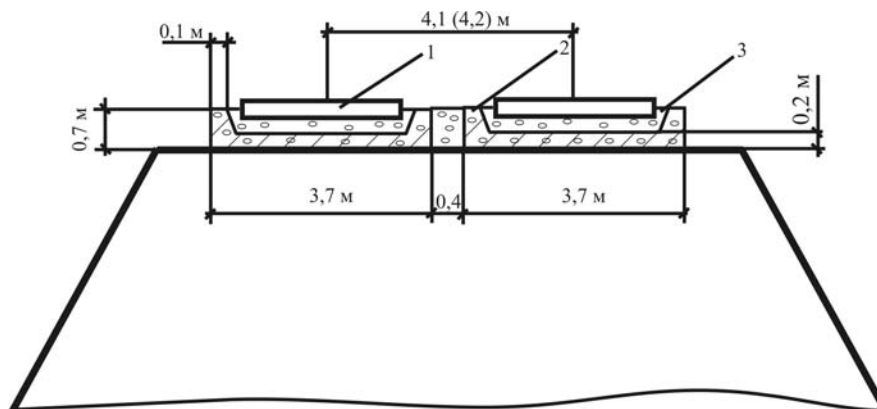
Схема земляного полотна із залізобетонним кріпленням баластної призми: 1 – залізобетонна шпала; 2 – залізобетонне кріплення; 3 – шар щебеню
